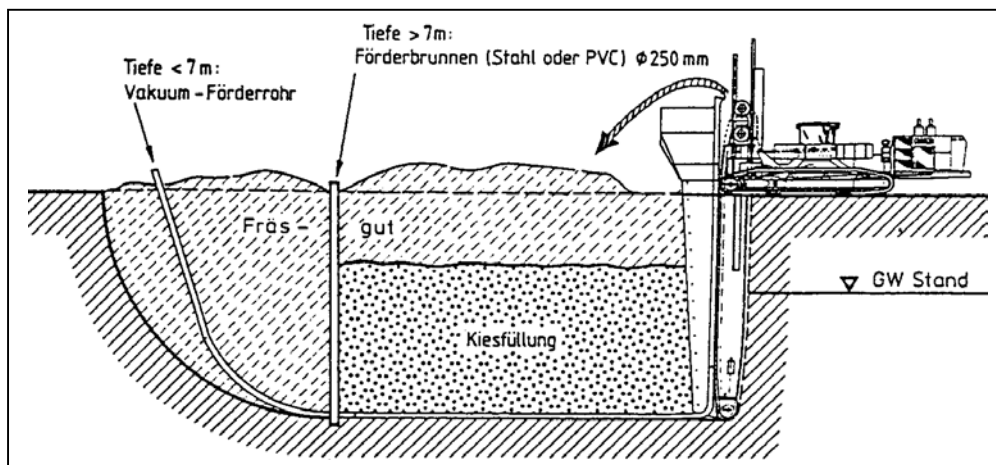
Verlegen einer Horizontaldränage mit einer Schlitzfräse
